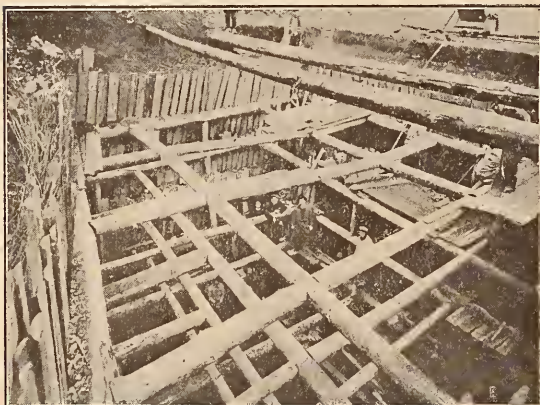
Fouille profonde, boisée pour la construction, à 12 mètres de profondeur, de la conduite en ciment armé.
